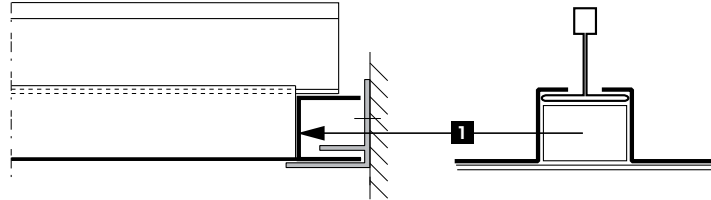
DETAILS-WANDANSCHLÜSSE DETAILS-WALL CONNECTIONS DETAILS CONNECT. MUR
